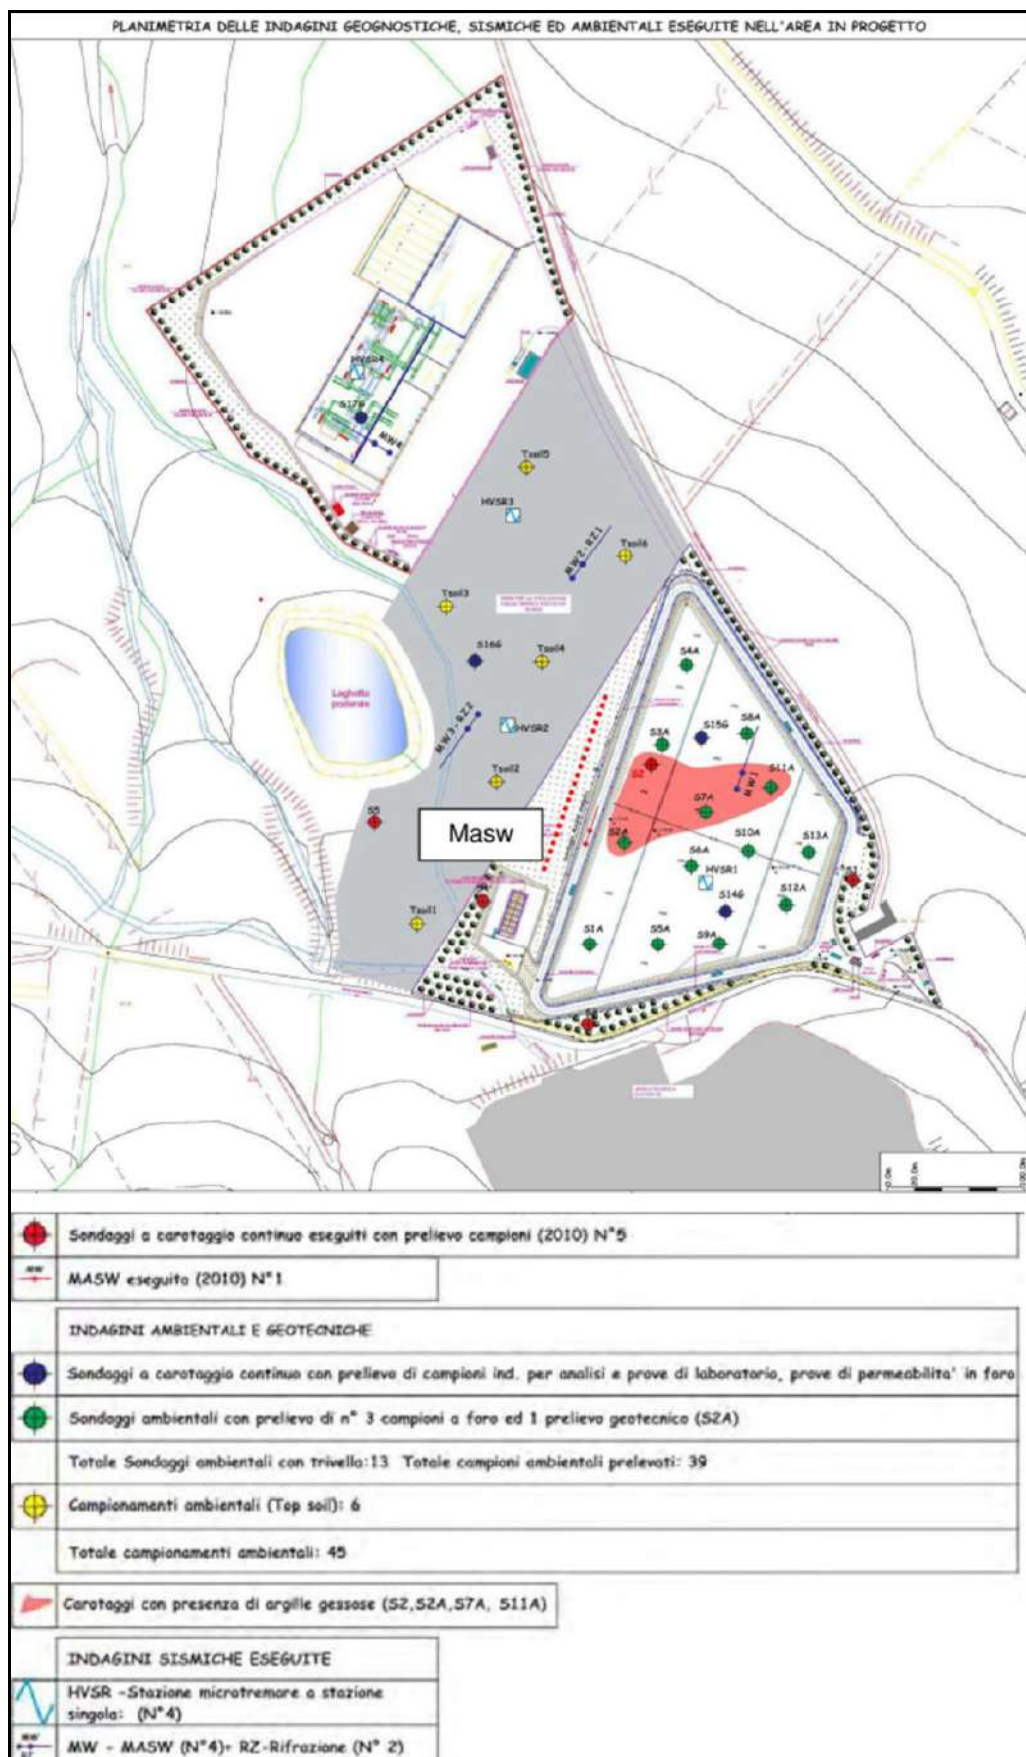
planimetria dello studio geologico di progetto con indicazione delle indagini eseguite in quel contesto
